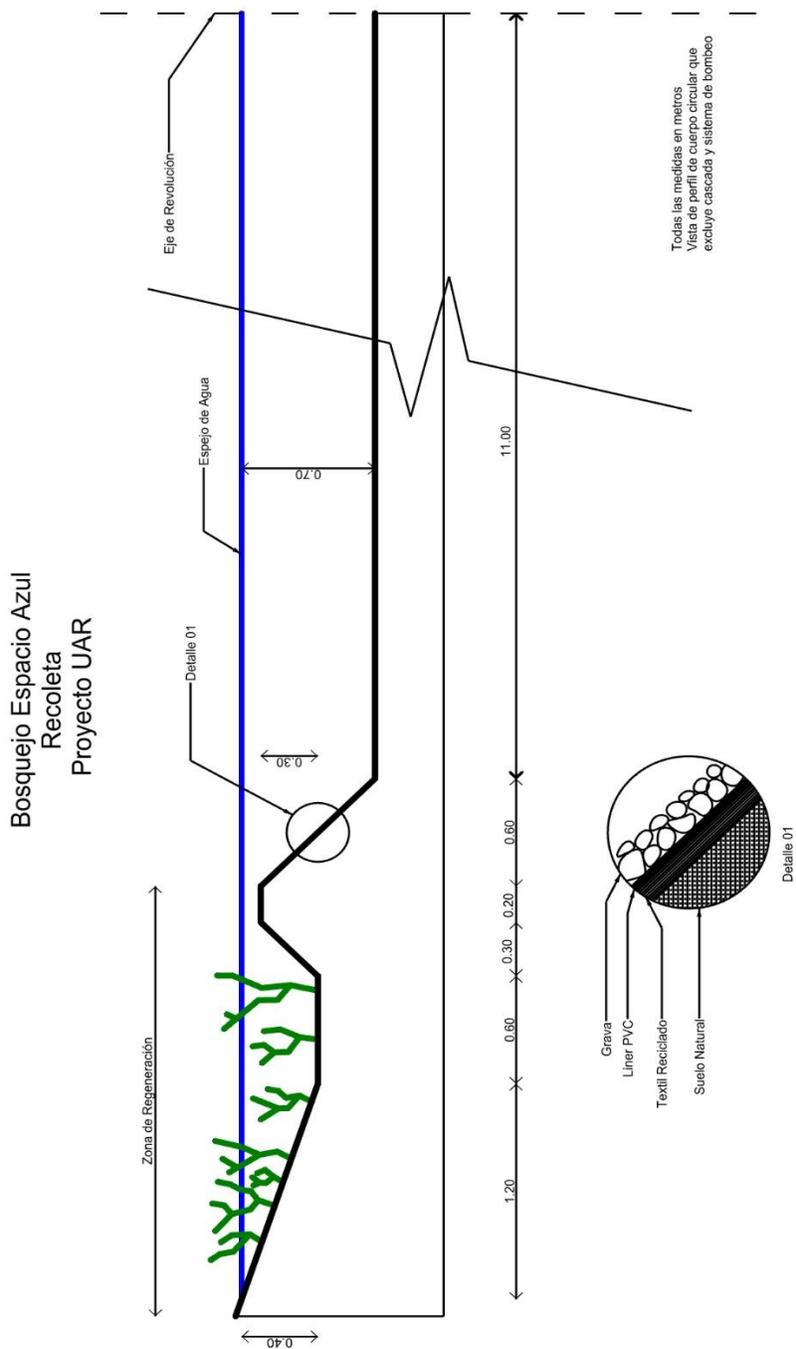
Bosquejo de Espacio Azul para Recoleta de planta circular en vista de perfil
